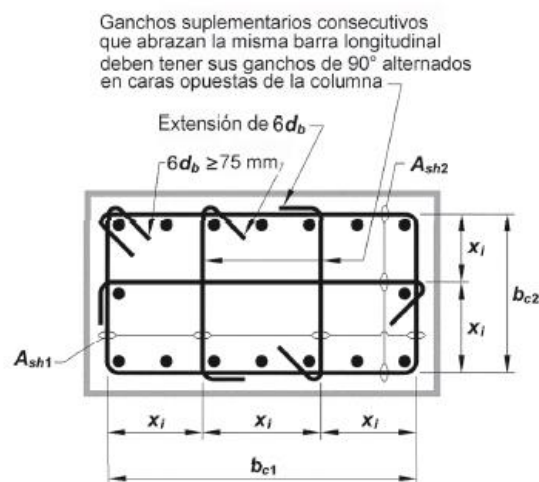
Ejemplo de refuerzo transversal en columnas (aplicable a cabezales para muros de corte).³⁷
